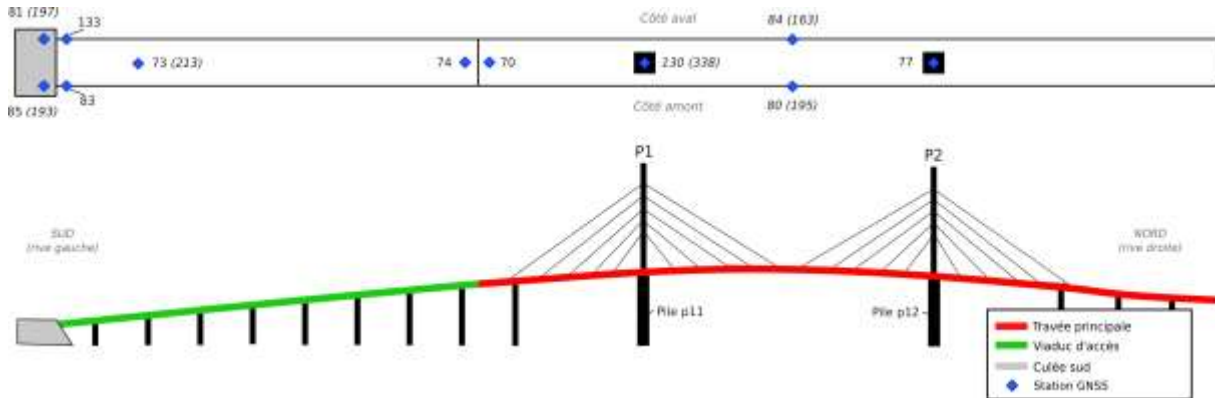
Plan d'installation des capteurs sur le pont de Brotonne
